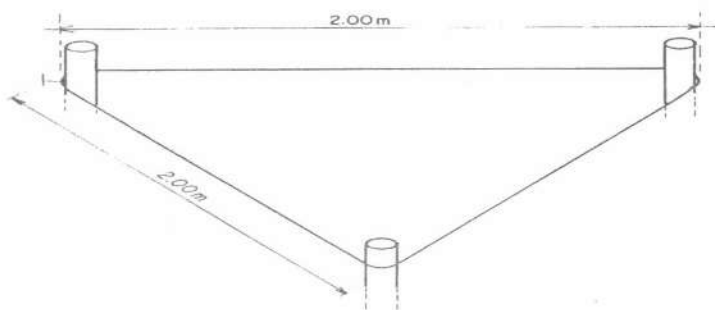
Conjunto de hastes "terra" em solo ocasionalmente seco.
